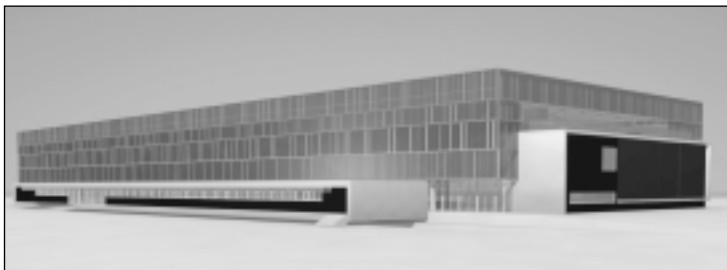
Façanes Nord i Oest. | *Fachadas Norte y Oeste.
